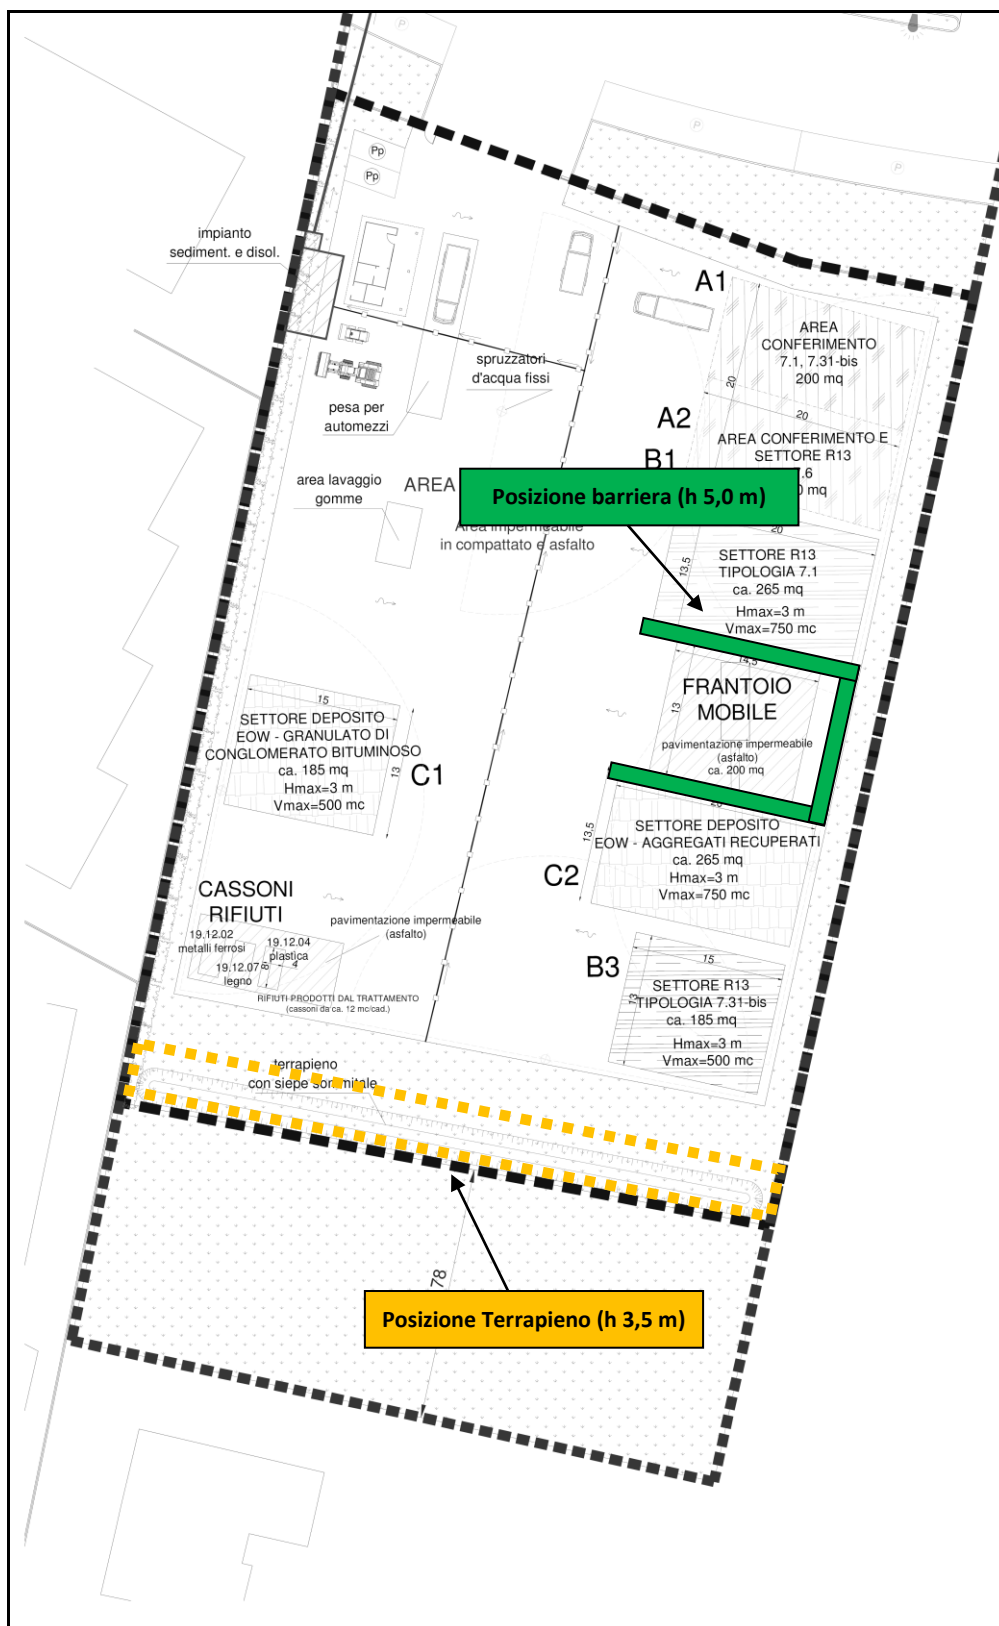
elaborati (layout piano terra, posizione barriera fonoimpedente e terrapieno)
